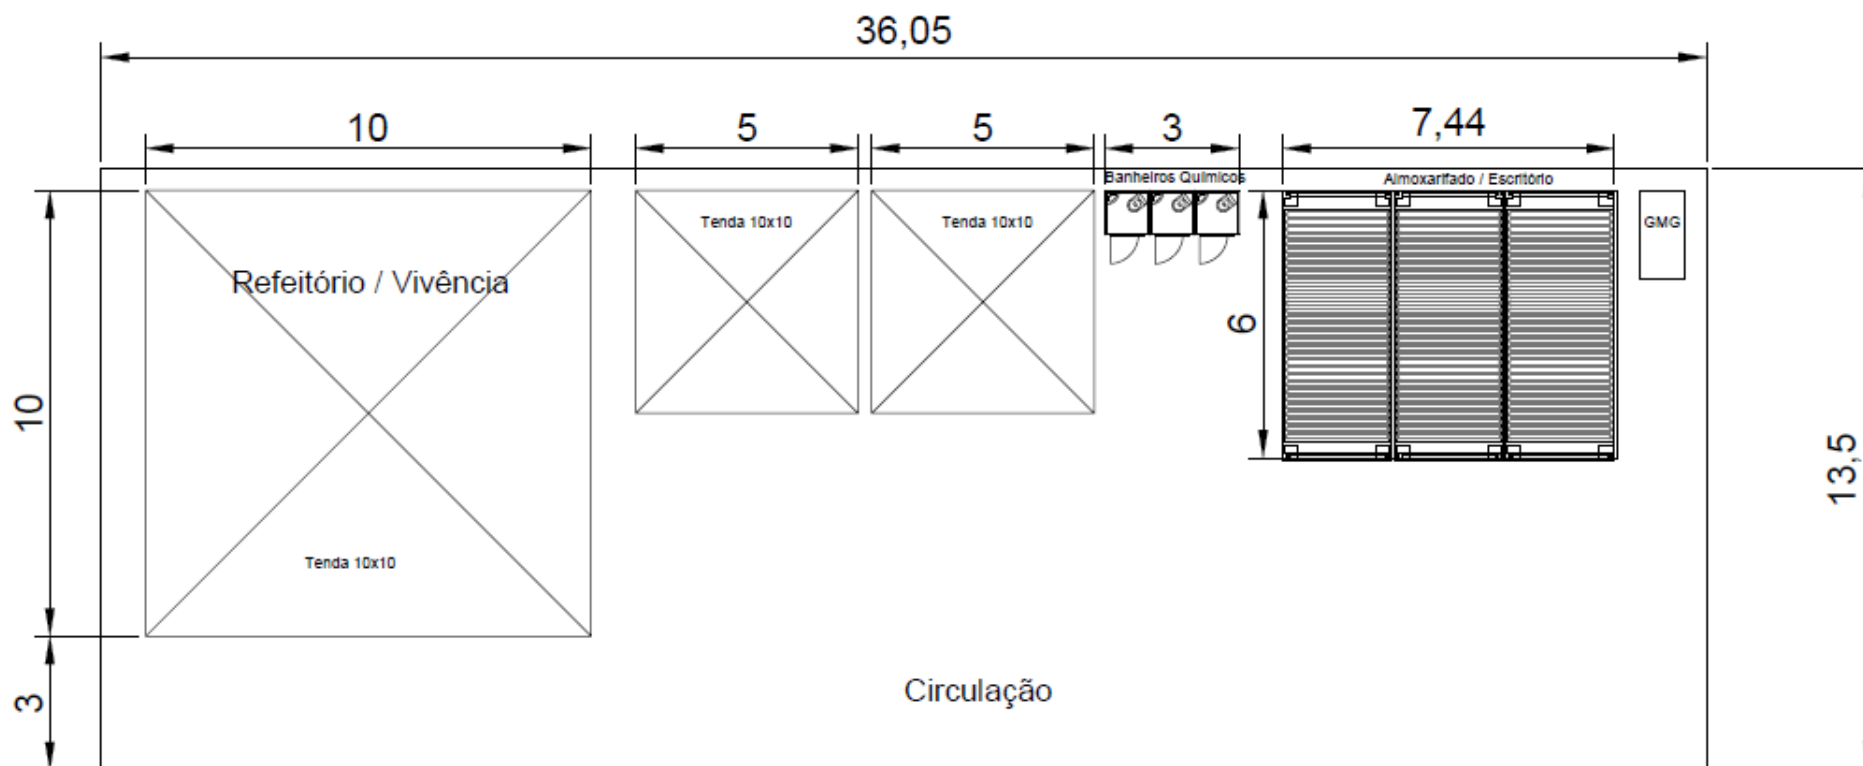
Exemplo de Planta Baixa - Infraestrutura básica para as frentes de obra.
